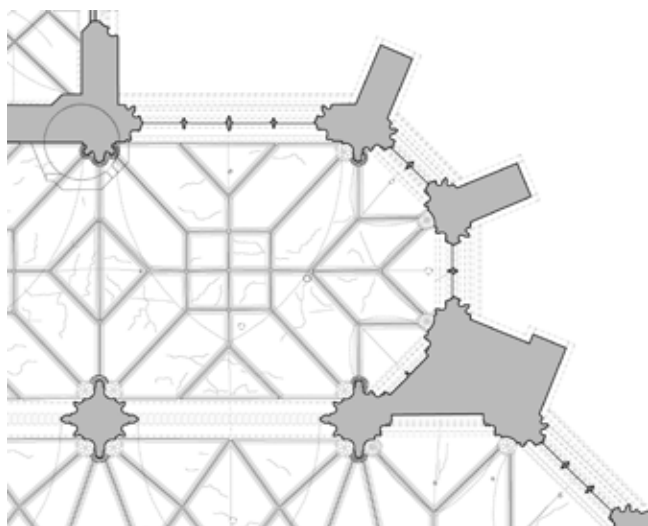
Stadtpfarrkirche Steyr – Ausschnitt Querschnitt und Emporengrundriss mit Gewölbeunterstützung: Profile der Pfeiler, Portale, Rippen und das Maßwerk lassen sich im Maßstab 1 : 5 ausgeben. Die Risskartierung erfolgte photogrammetrisch.
